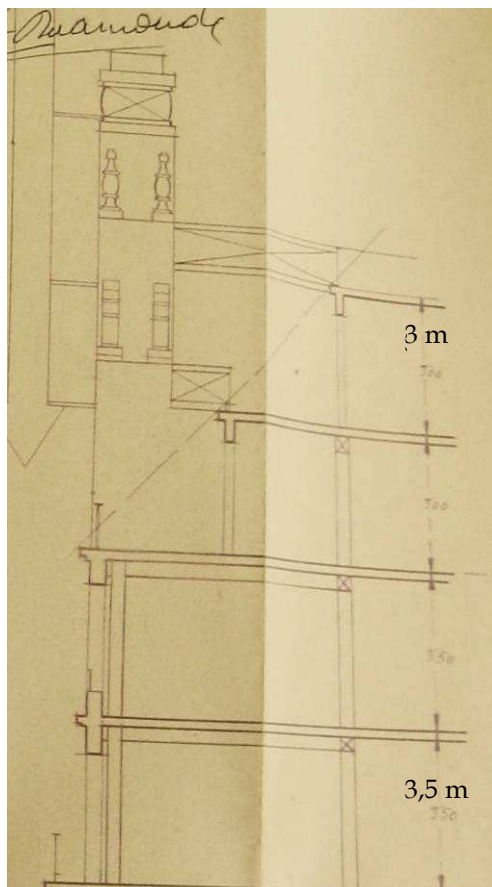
Sección de últimas plantas Edificio 62C.002, 1941.
